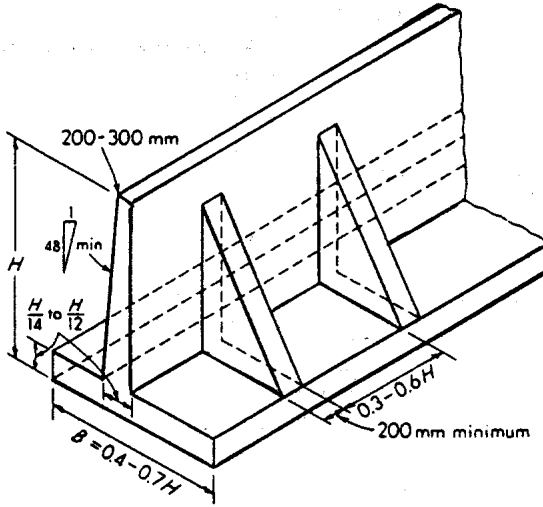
أبعاد الحائط الساند الكابولي
